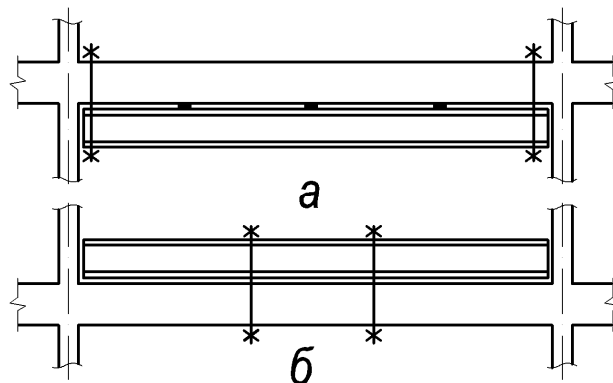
Підсилення балки елементами, що розвантажують:
